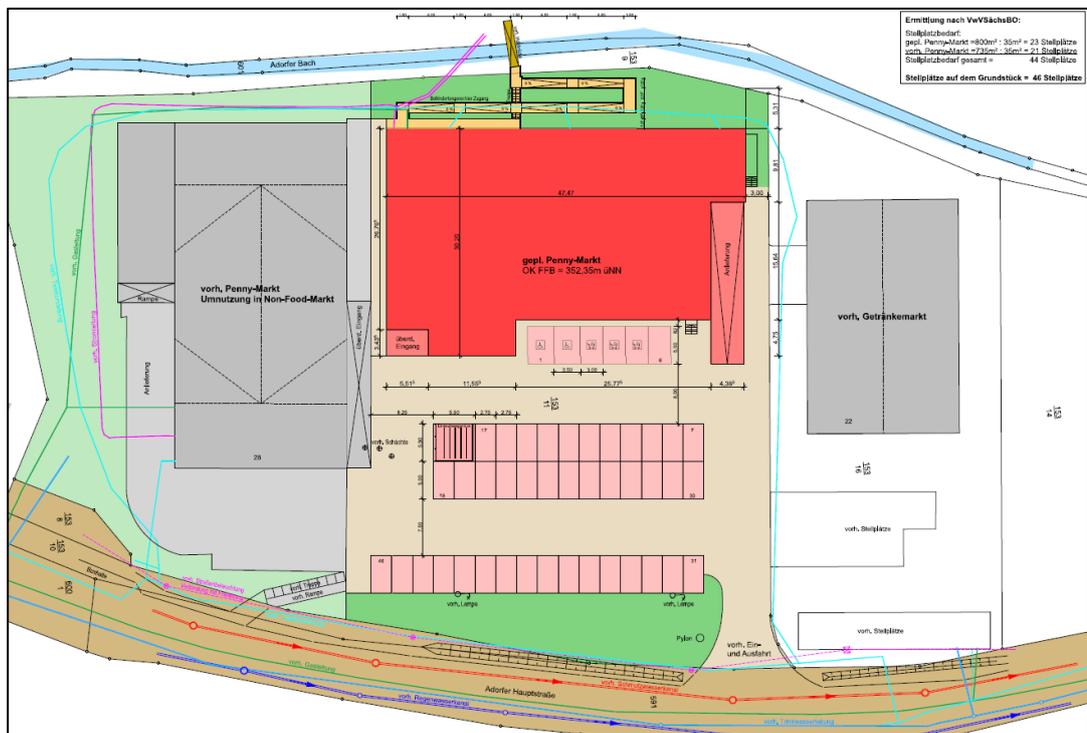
Lageplan Penny-Vorhaben<sup>26</sup>
